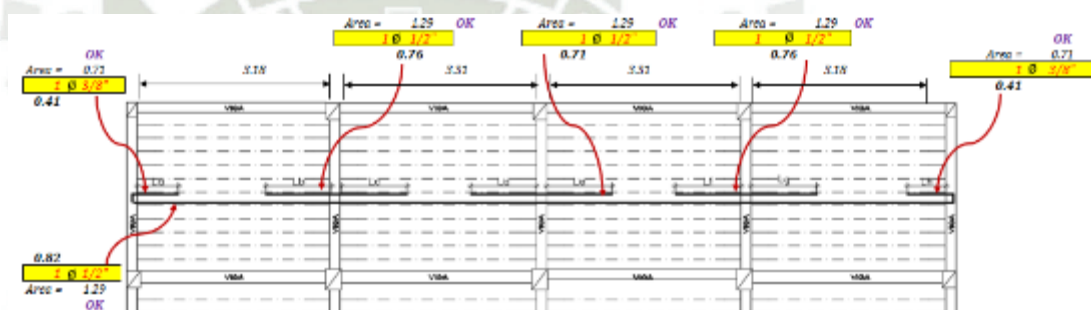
Distribución de acero en plano de planta (Deriva máx = 0.007)
